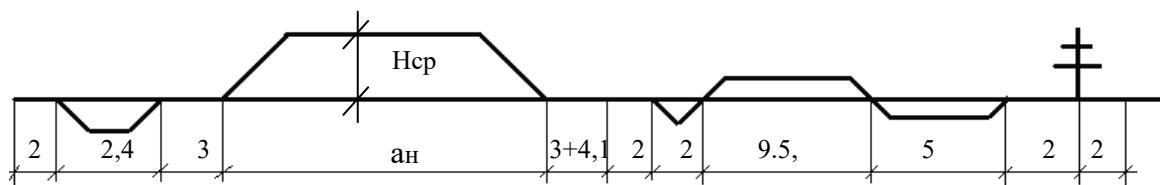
Поперечный профиль земляного полотна на участках где насыпь отсыпается из выемки или карьера
